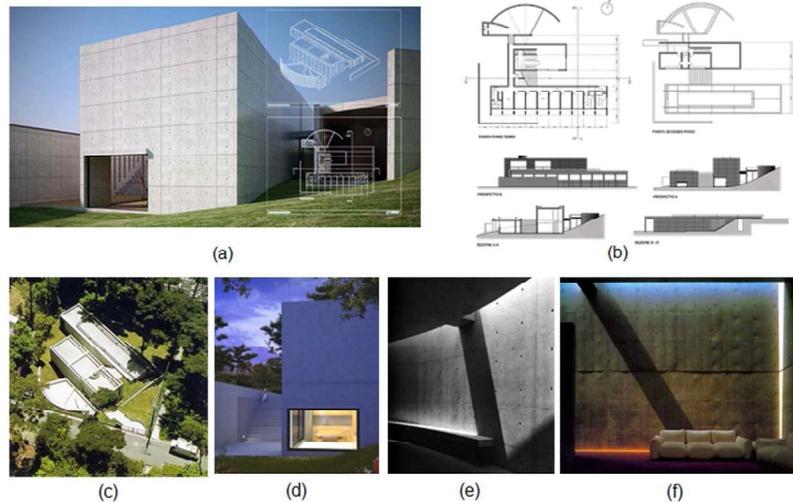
Tadao Ando, Casa Koshino, Osaka, Japón, (1981): (a) Vista exterior fachada principal, (b) Plantas arquitectónicas, Alzados y Secciones transversal – Longitudinal, (c) Vista aérea, (d) vista exterior, (e) y (f) Detalles interiores.
